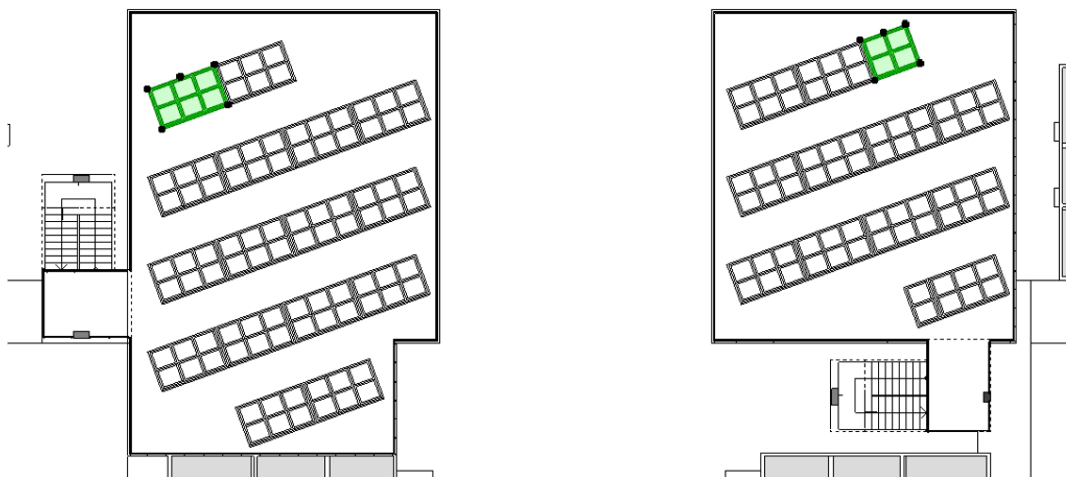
Planta esquema de disposición, cantidad y ubicación de paneles fotovoltaicos en el nivel de cubierta +14,00 - Bueno,E. 2021
